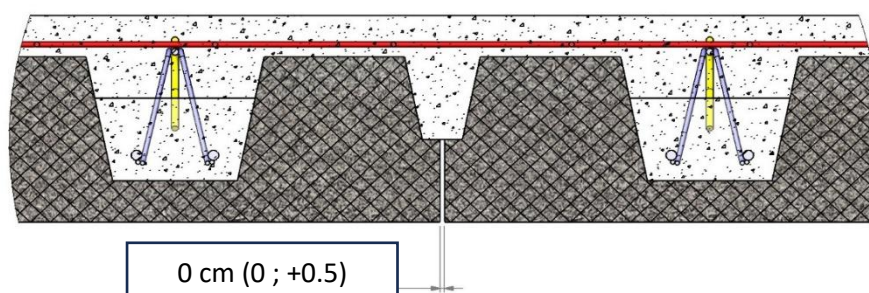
bis : Géométrie et jeu de l'assemblage de deux prédalles
